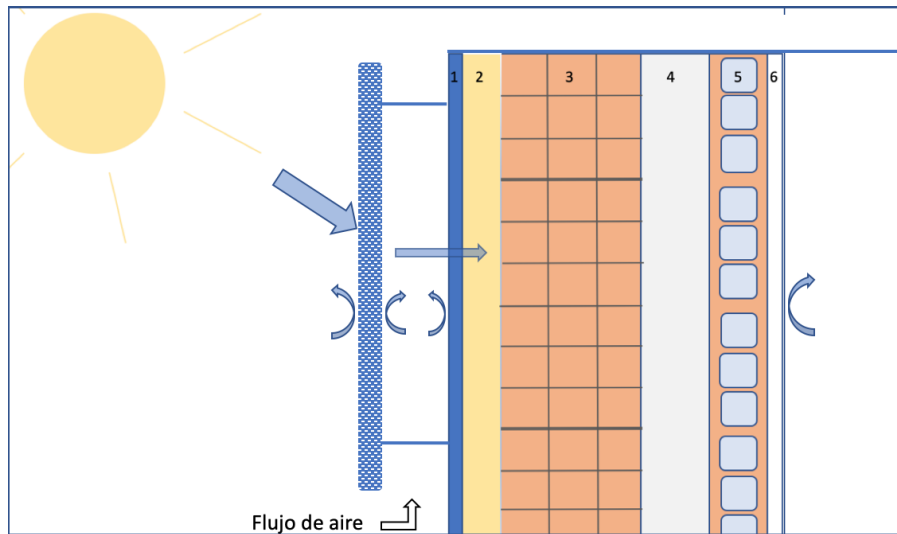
Fachada de doble hoja del año 1970 con paneles verticales fotovoltaicos instalados. Las capas de material de la fachada es la misma que en la figura 3.1.
